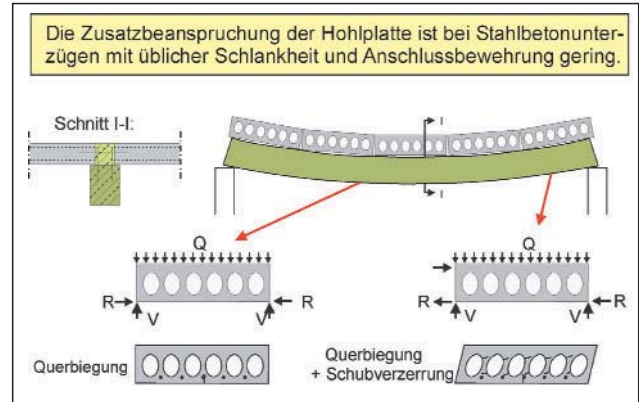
Spannbeton-Hohlplatten bei Auflagerung auf Stahlbeton- und Spannbetonunterzügen
